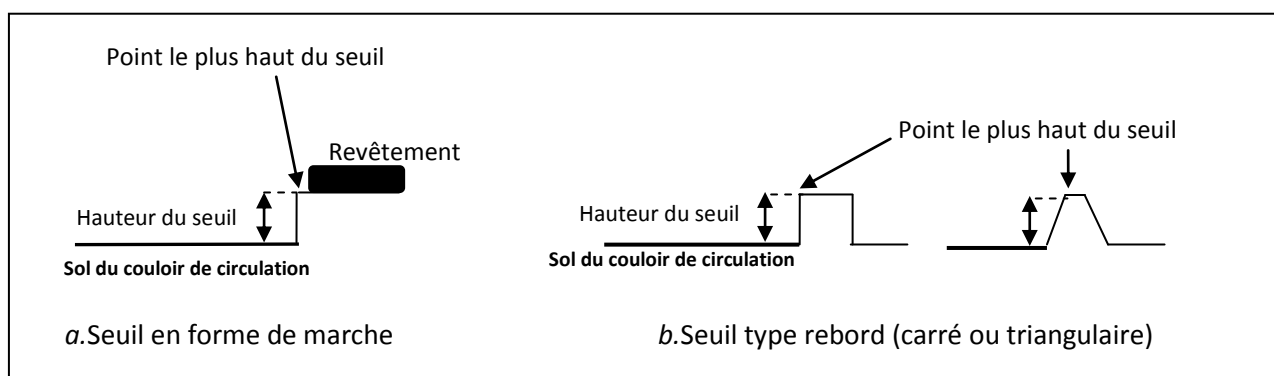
Hauteur du point le plus haut du seuil de la logette : exemple d'un seuil en forme de marche (a) et d'un seuil type rebord (b)
